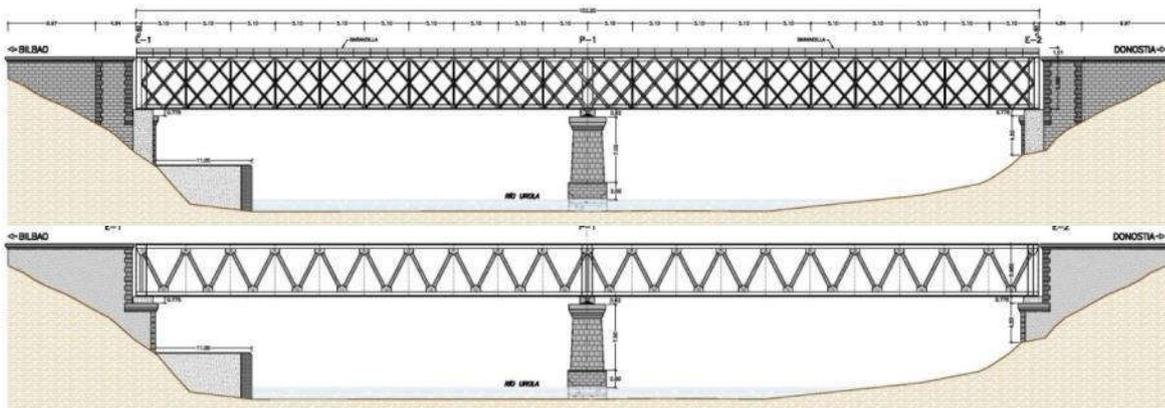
Alzado lateral y central del puente sobre el río Urola
